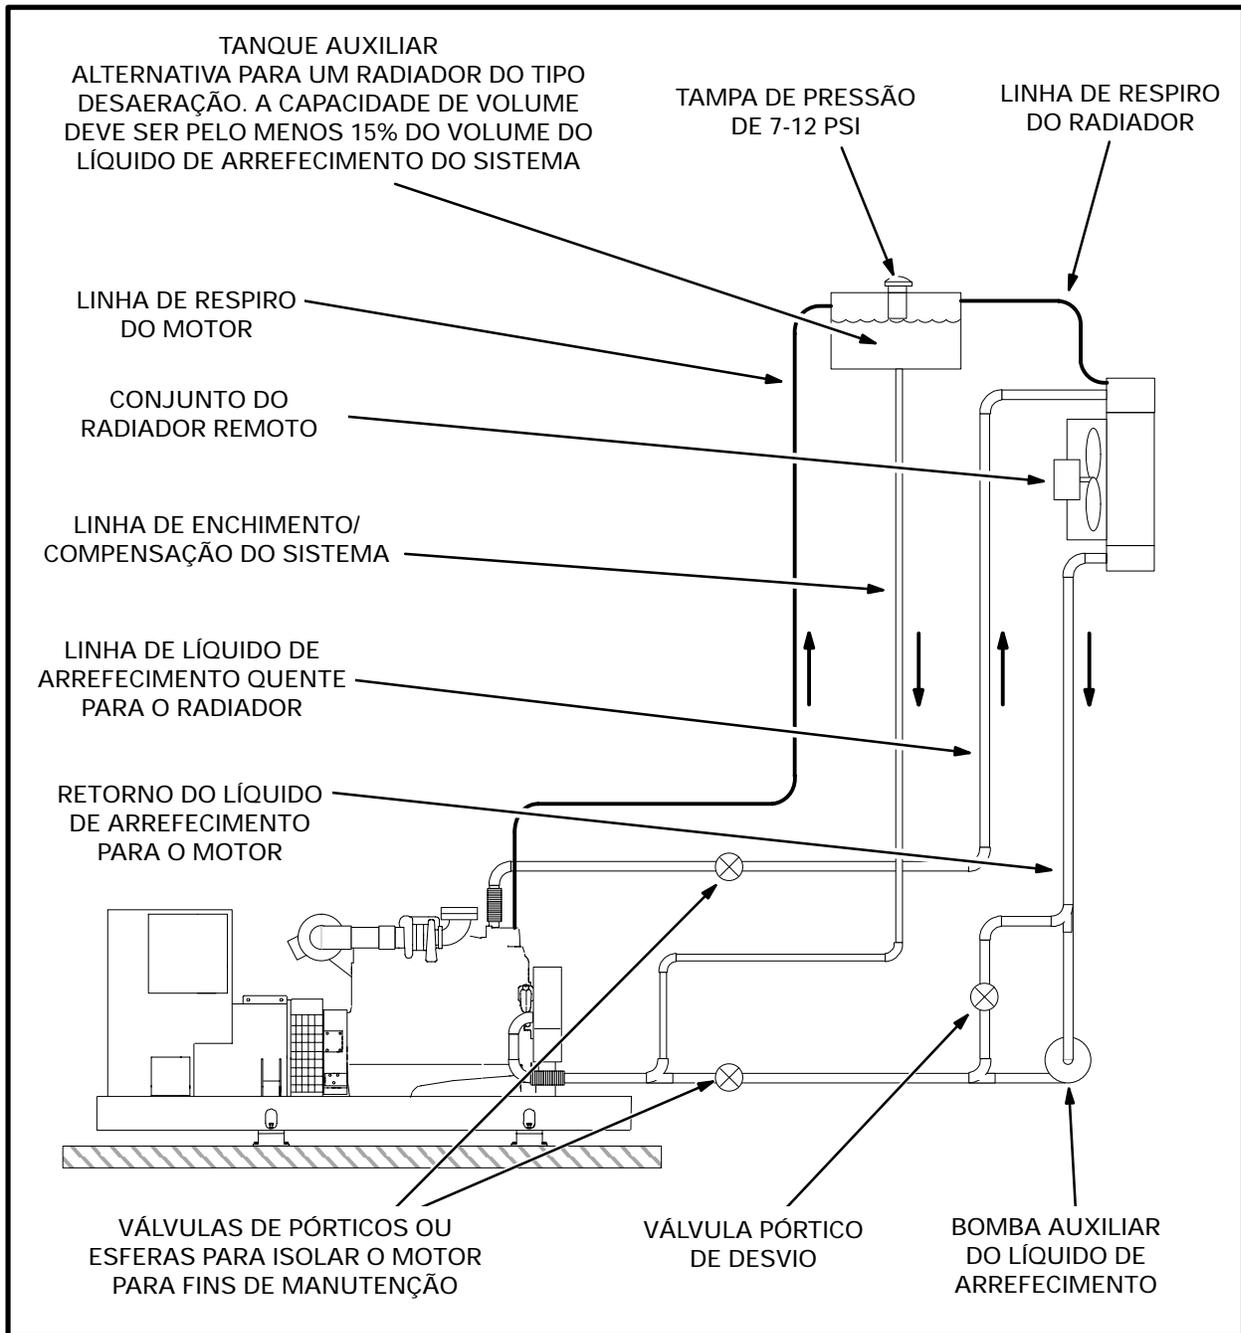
Radiador Remoto com Bomba de Arrefecimento Auxiliar e Tanque Auxiliar
